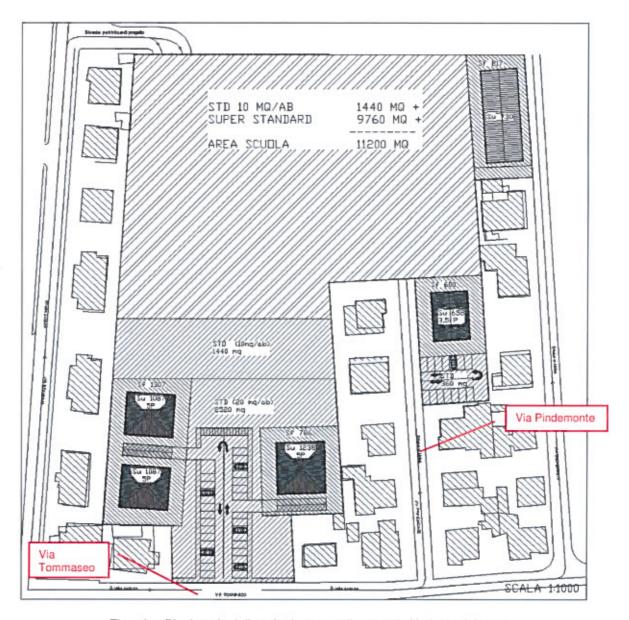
b - Planimetria della scheda 13.19 allegata alla Variante del 2009
